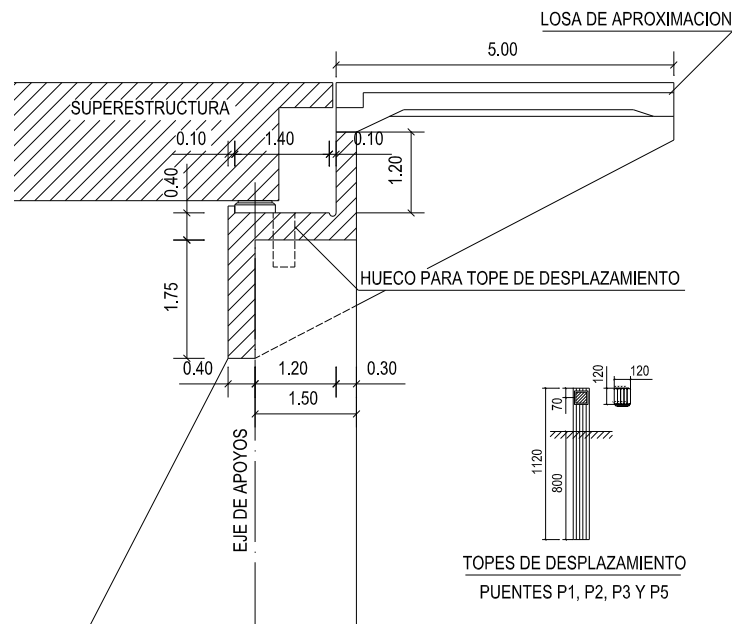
Sección transversal en el sector de estribos de los puentes P1, P2, P3 y P5.
